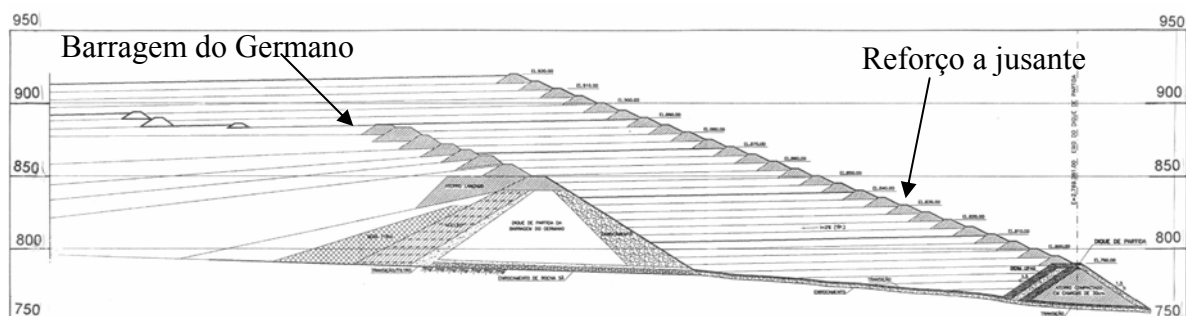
Seção transversal típica da Barragem do Germano, da UIG / Samarco (Pimenta de Ávila, 2003b).
